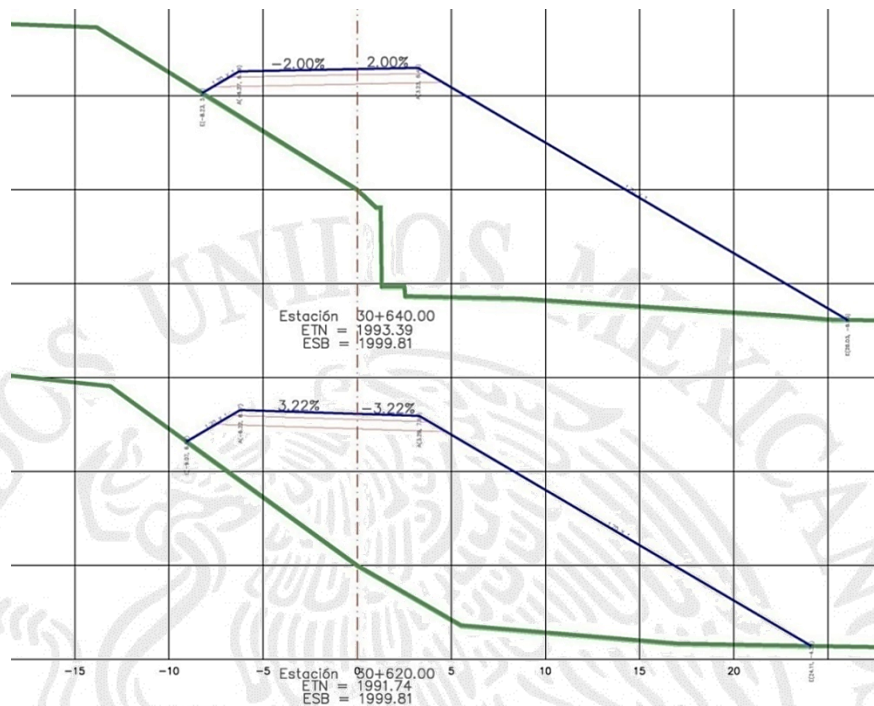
Secciones de los km 30+620 y km 30+640 del Eje 30 con cambio de pendiente transversal
